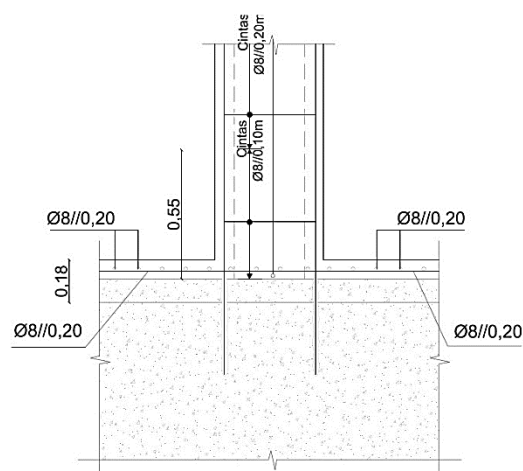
Detalhe de armadura no nó entre a laje do piso 0 e pilar
